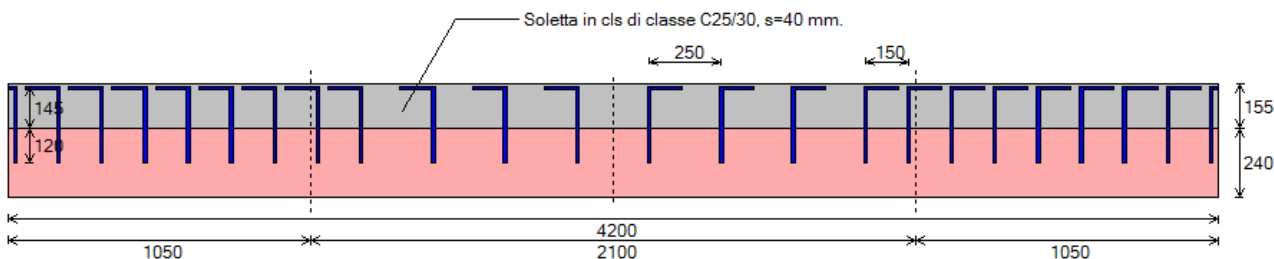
Grafica: Sezione C-C: Prospetto Trave
